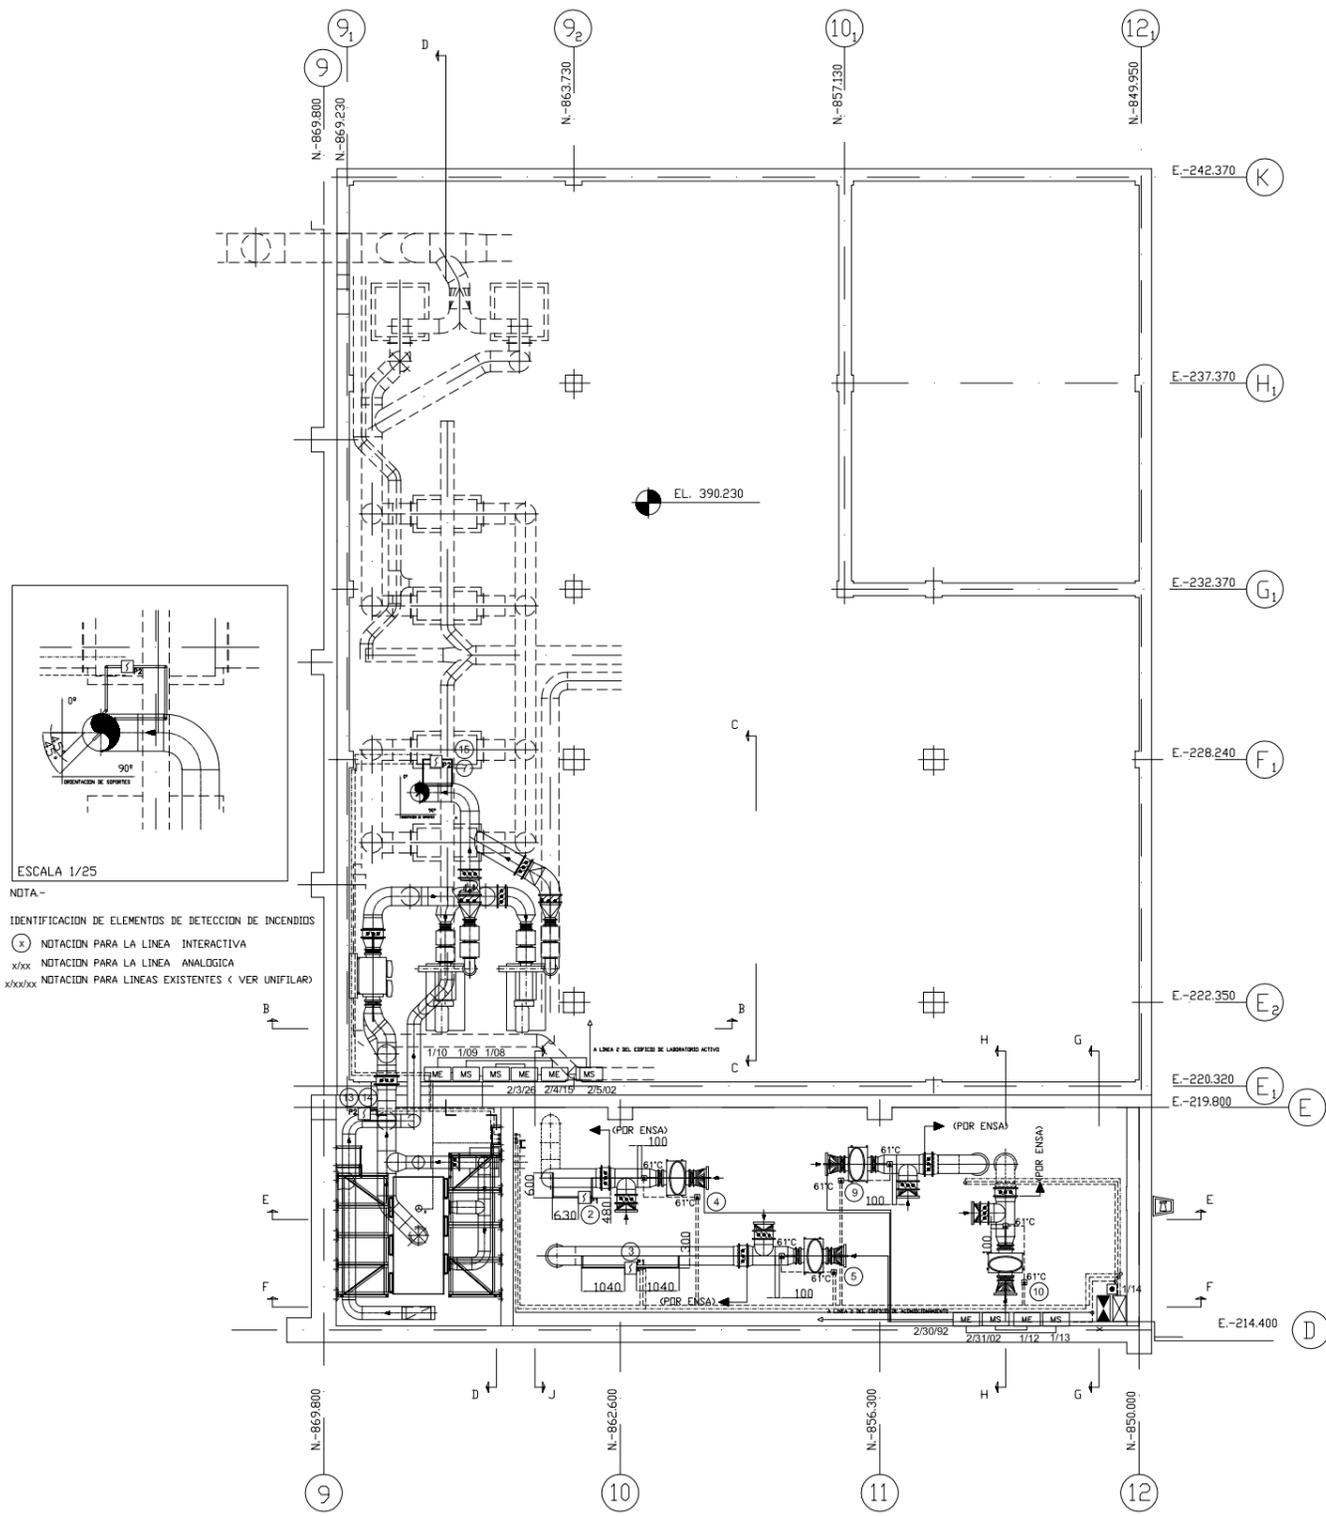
PLANO DE DISPOSICIÓN ALZADO - EXTRACCIÓN RMTA
